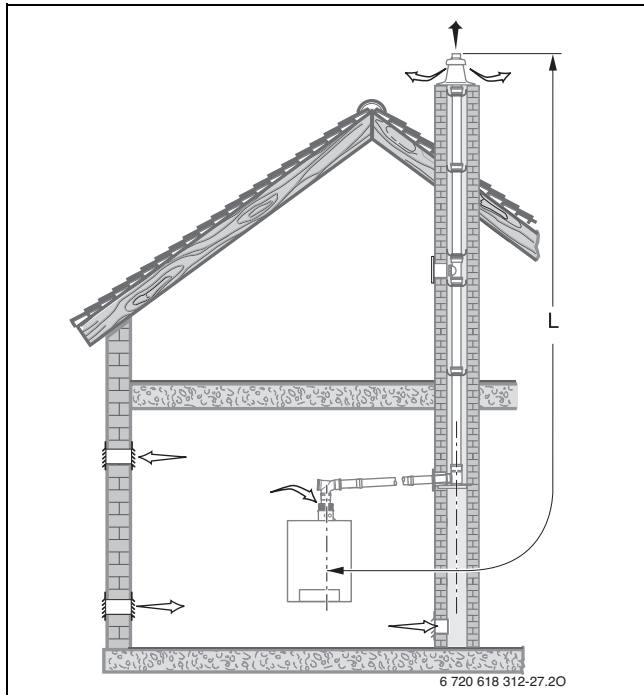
B₂₃: Abgasführung über hinterlüftete Abgasleitung Ø 100 mm im Schacht
